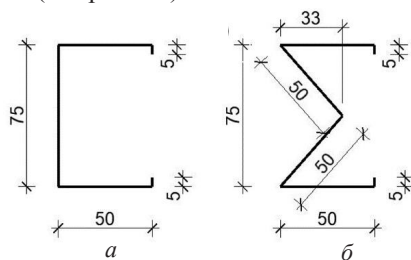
Типы вертикальных стоечных профилей каркаса:  $a$  – стандартный профиль типа швеллер;  $b$  – сигма-образный профиль
